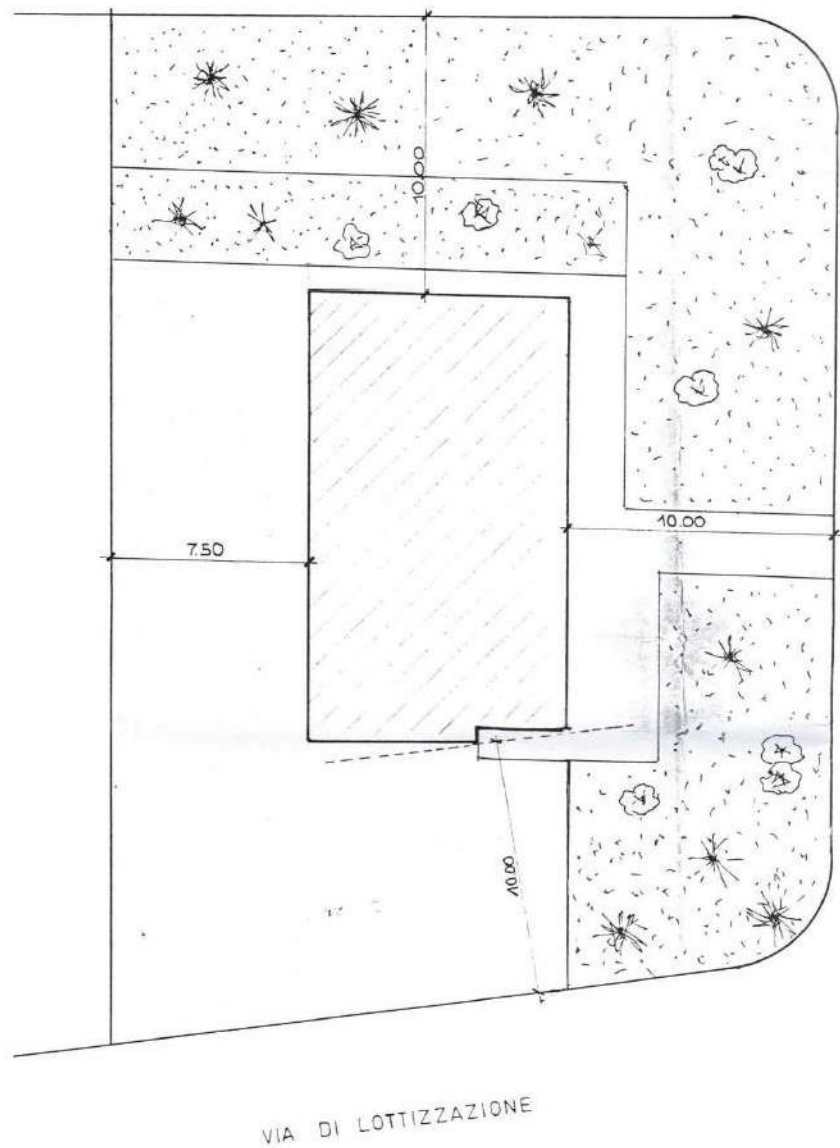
Planimetria del lotto con ubicazione corpo di fabbrica (concessione n.173/97)
